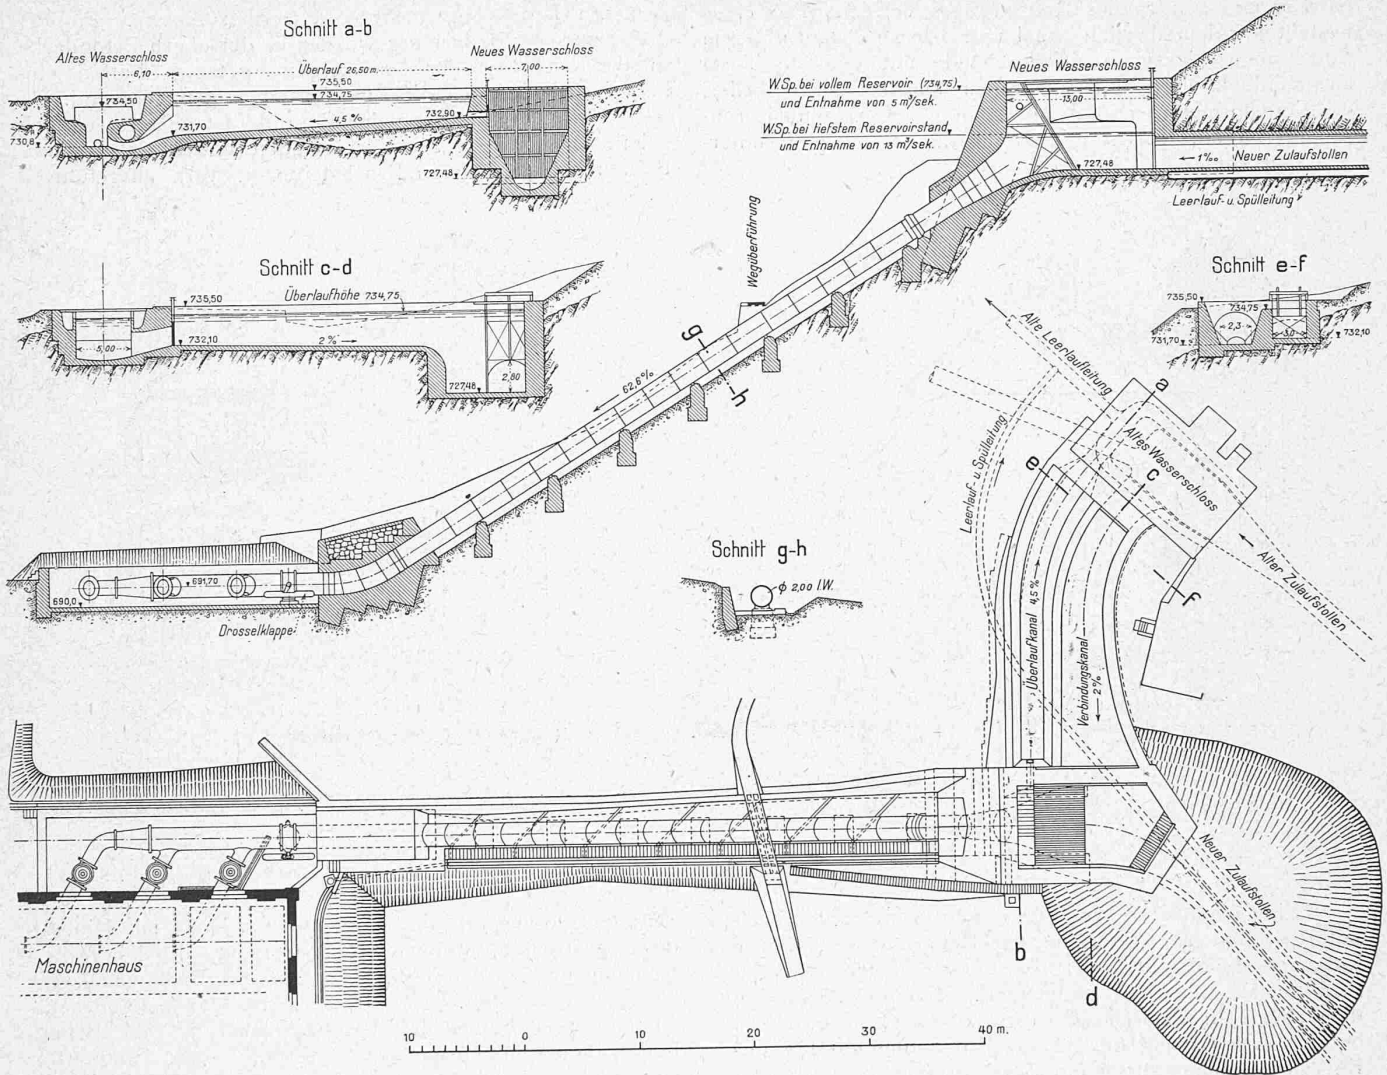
Grundriss, Längs- und Querschnitte von Wasserschloss und Druckleitung. — Masstab 1:600.
